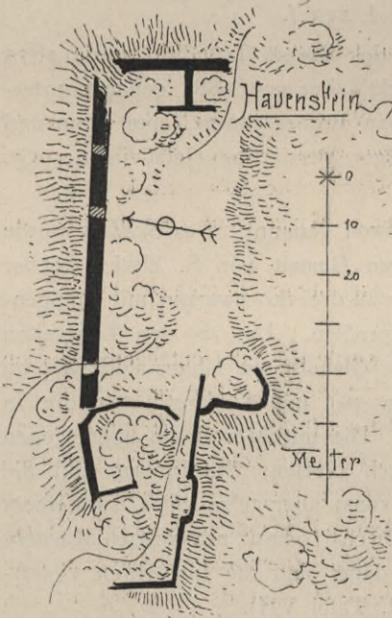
Hauenstein. Grundriss der Burg.
